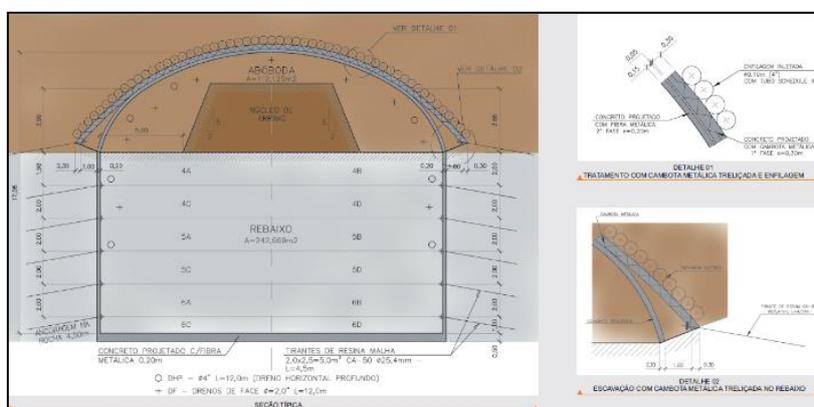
Execução do desemboque do túnel, com detalhe à escavação do rebaixe e tratamento da abóbada. Fonte: CONSÓRCIO ARG-CIVILPORT (2010)
